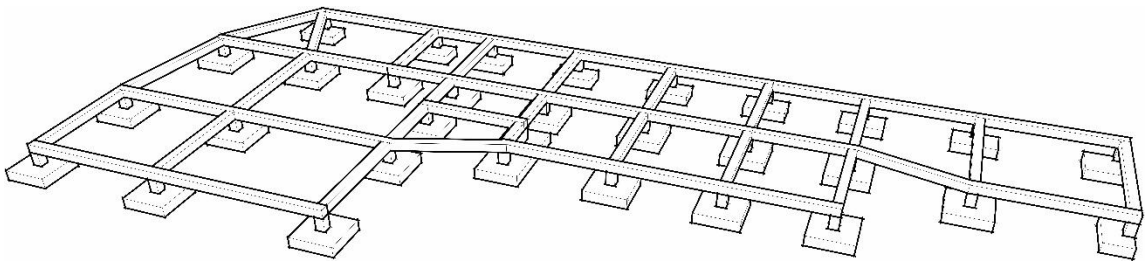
Propuesta de cimentación y estructura de vigas y columnas.
